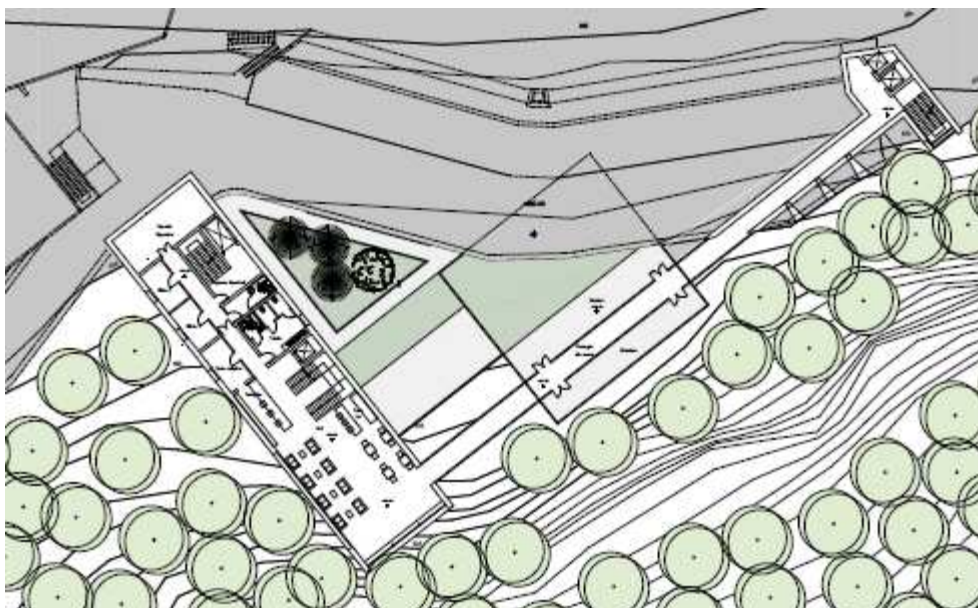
pianta piano terra della hall e corridoio di collegamento alle camere
